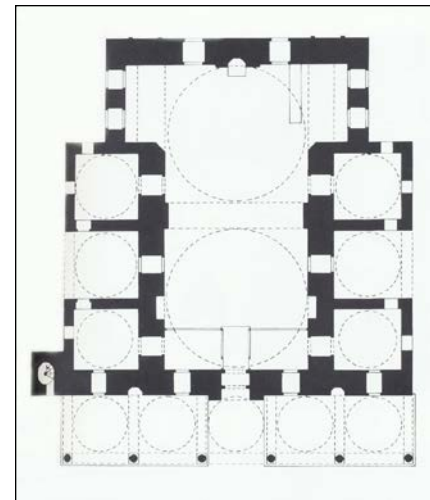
Gedik Ahmet Moschee, Ayfon, Grundriss
